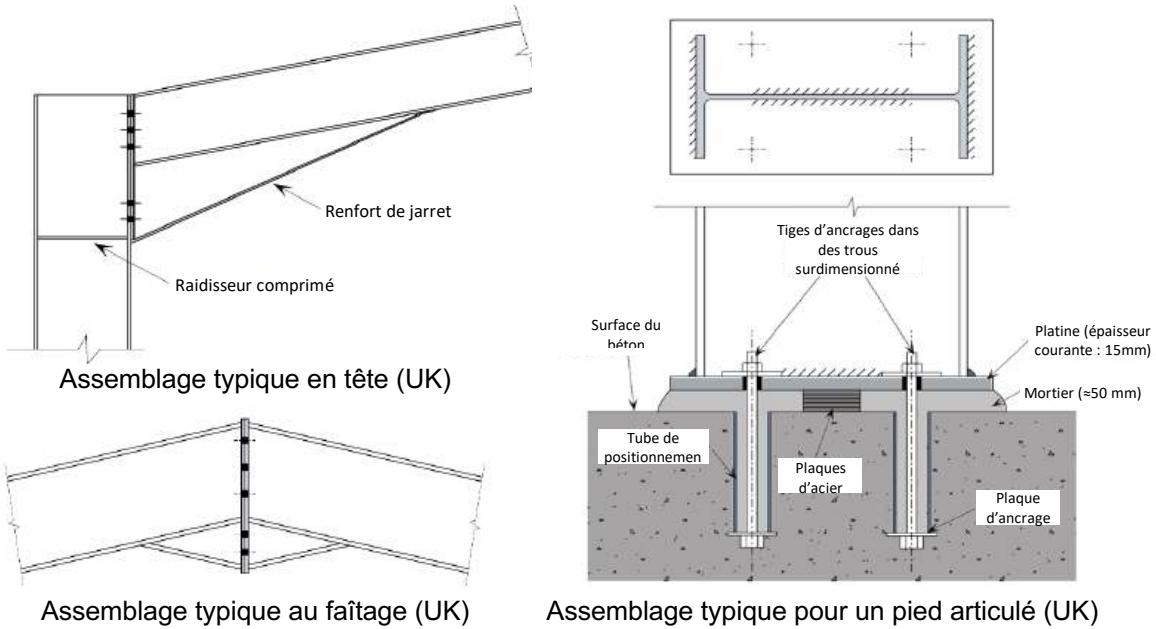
Détail typique d'un portique à une travée avec des pieds nominalement articulés
